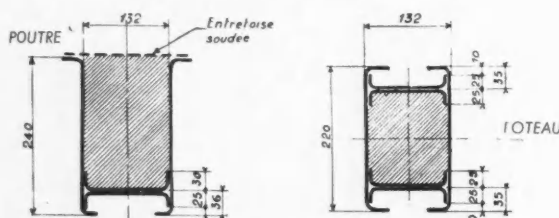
Quelques profils d'un usage courant en construction soudée
